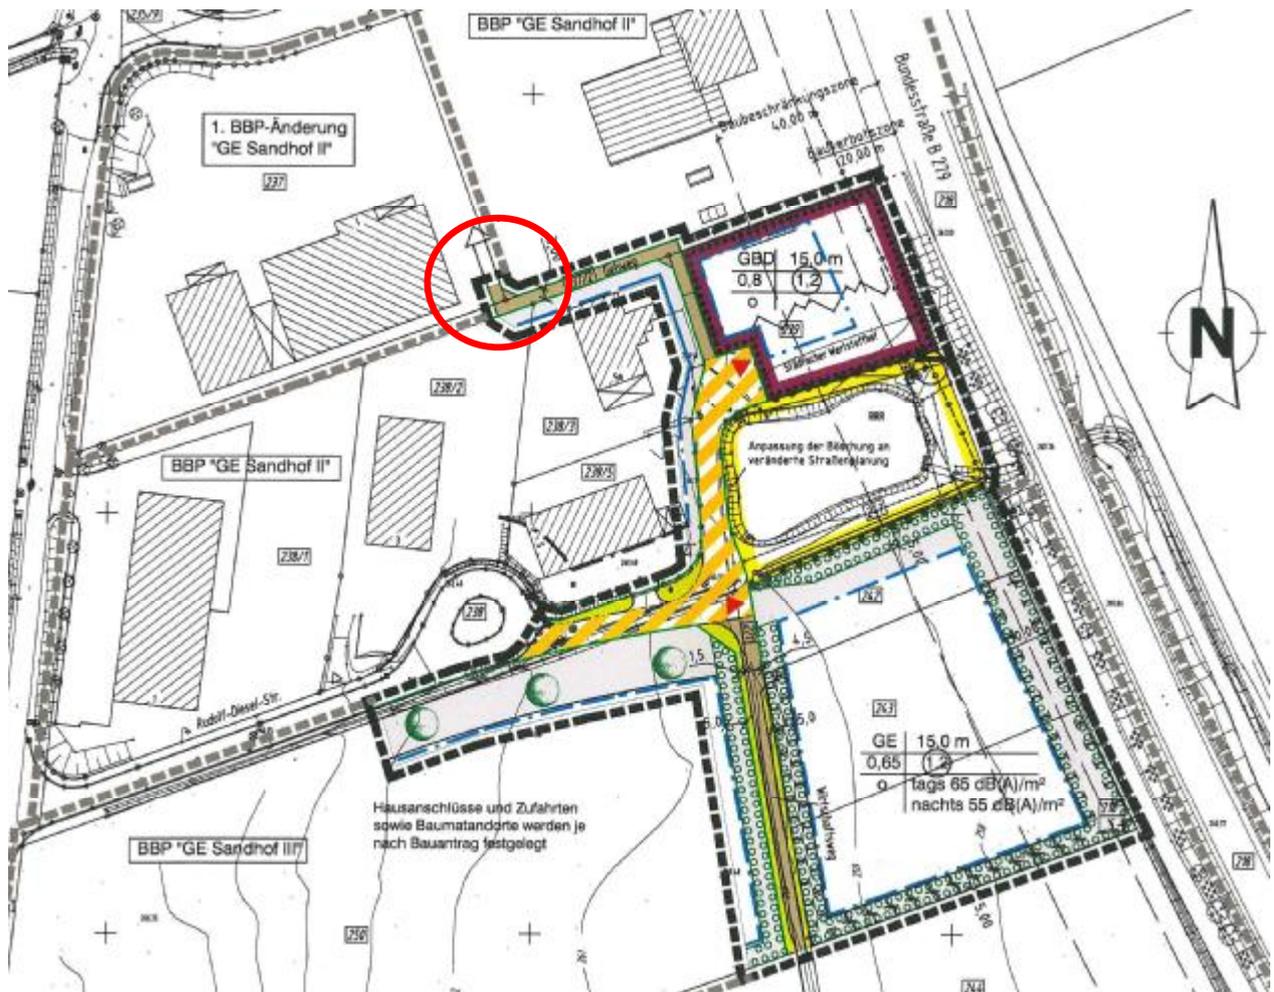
Auszug 2. Bebauungsplan-Änderung "GE Sandhof II" mit 1. Änderung "Sandhof III" vom 29.01.2004, Quelle: Stadt Ebern
